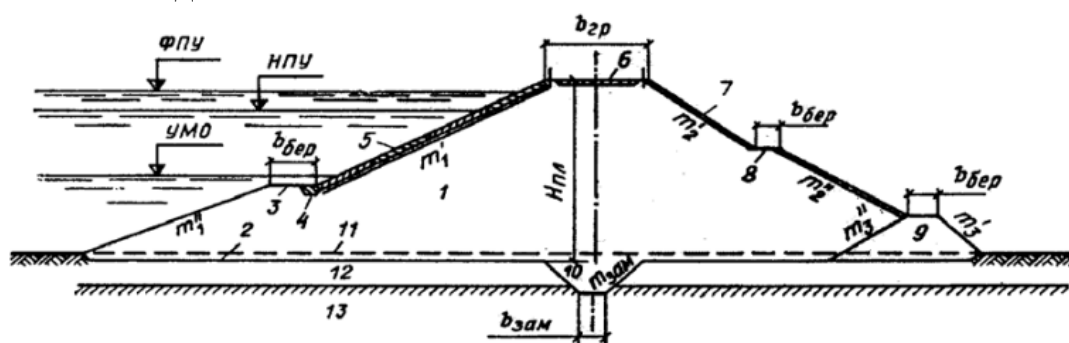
Поперечный профиль грунтовой плотины: 1 – тело плотины; 2— подошва плотины; 3 – берма верхового откоса; 4 – упор крепления; 5 – крепление верхового откоса; 6 – гребень плотины; 7 – крепление низового откоса; 8 – берма низового откоса; 9 – дренаж; 10 – замок; 11 – естественная поверхность грунта; 12 – водопроницаемый грунт; 13 – водопупор
